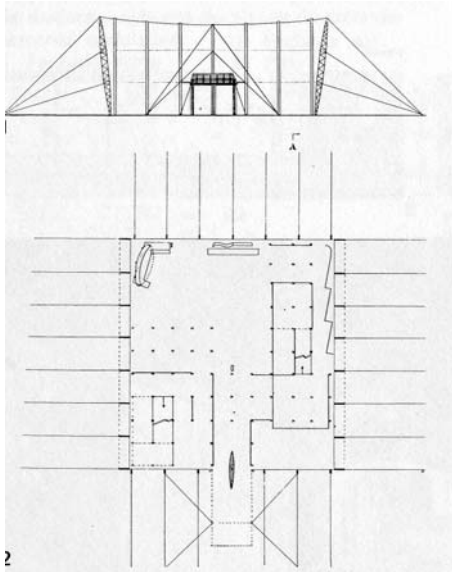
Alzado y planta del Pabellón des Temps Nouveaux, donde se expresa la ligereza de la construcción a base de lonas y cables
